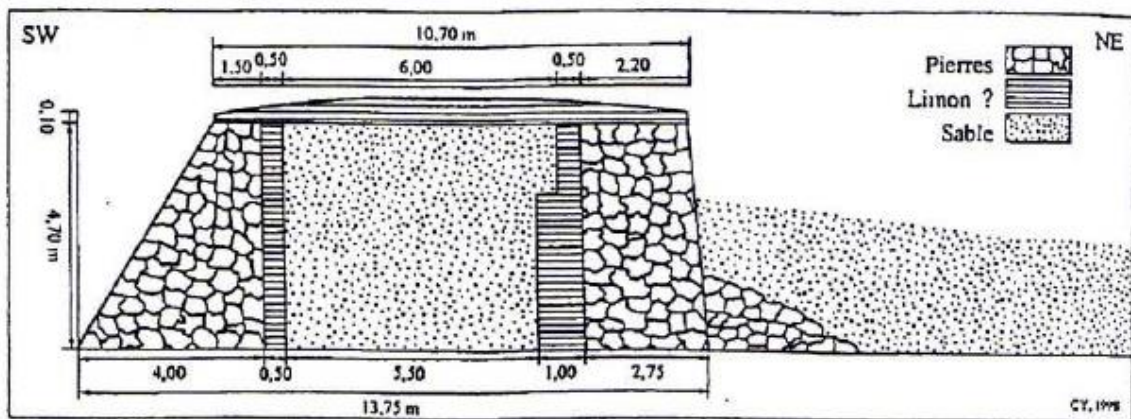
Schéma en coupe de la structure de la digue lors de sa construction (DocOb Guissény)
